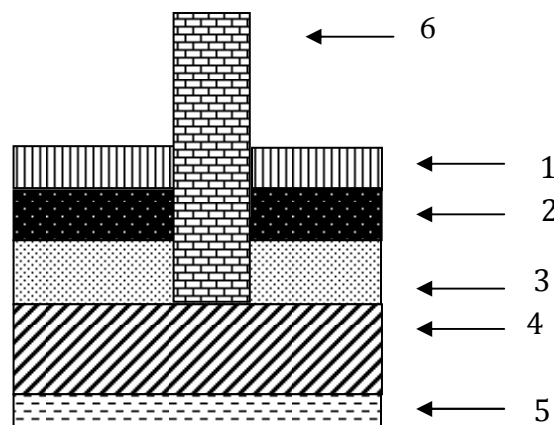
Coupe verticale de plancher d’étages courant de dalle pleine
